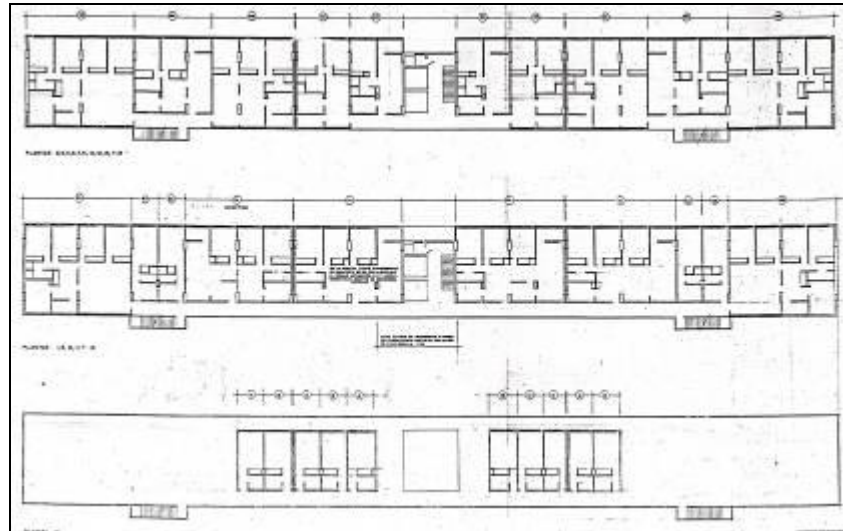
d. Superbloque Multicelular Cerro Piloto. Plantas
